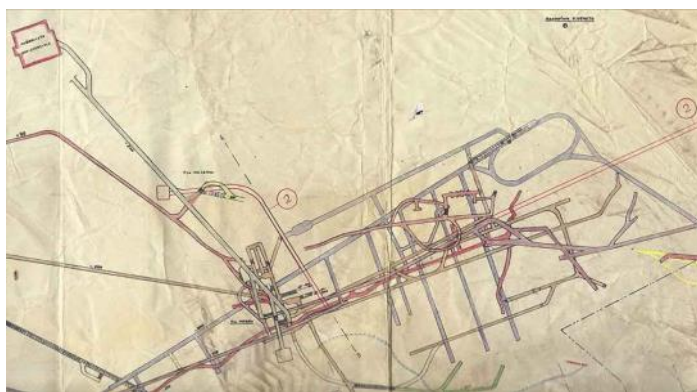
Miniera Montecatini a Gavorrano (Grosseto): dettaglio dei cantieri sotterranei con gallerie di carreggio, di coltivazione e il Pozzo Valsecchi.
